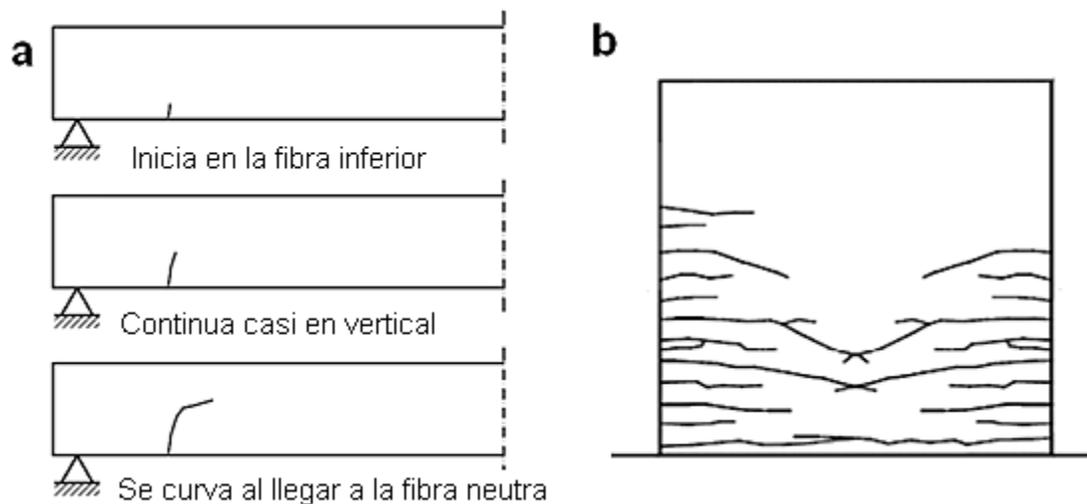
a) Proceso de una fisura por flexión en viga (Pérez, 1994), b) Fisuras por flexión en pared (Hurtado, 2014).
